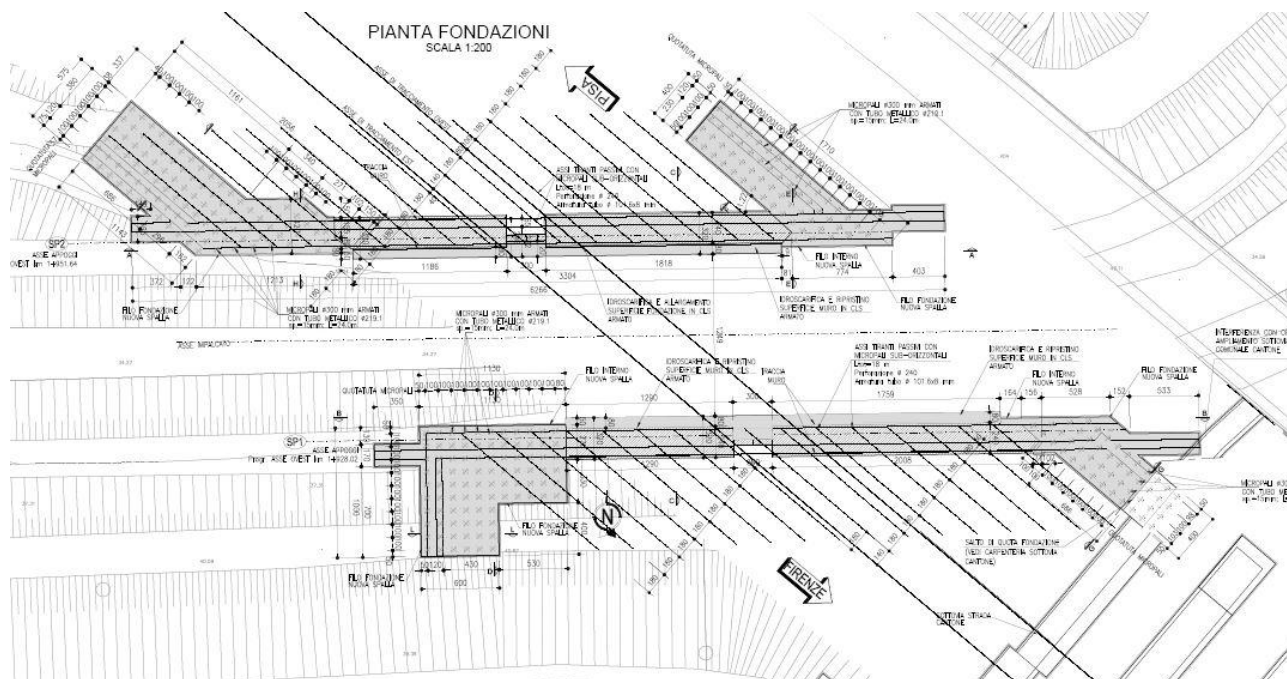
Planimetria di progetto opere di fondazione.
